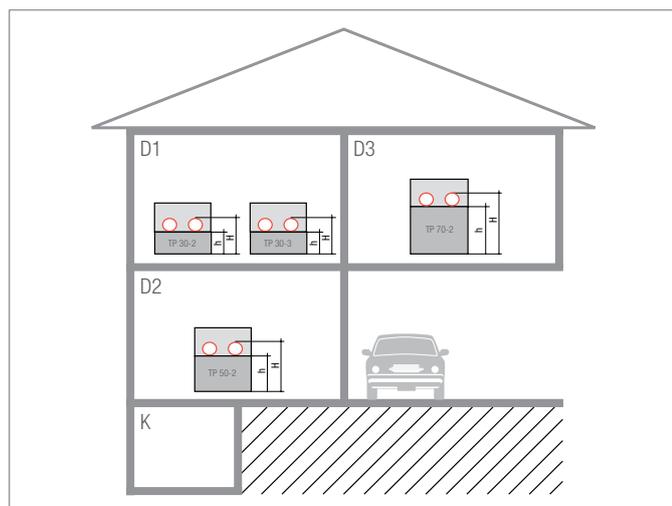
Isolation thermique minimale des planchers avec le système Tacker K Cave
